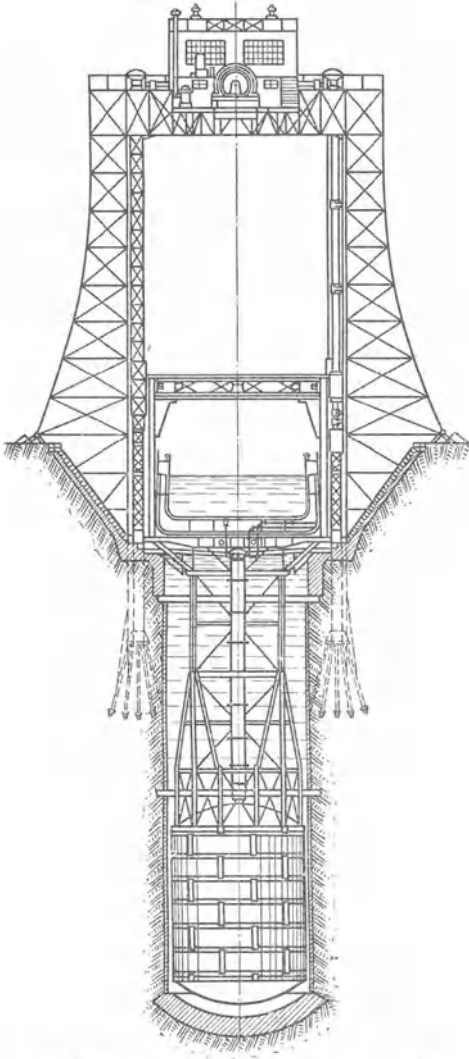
Querschnitt vor dem Führungsgerüst.
